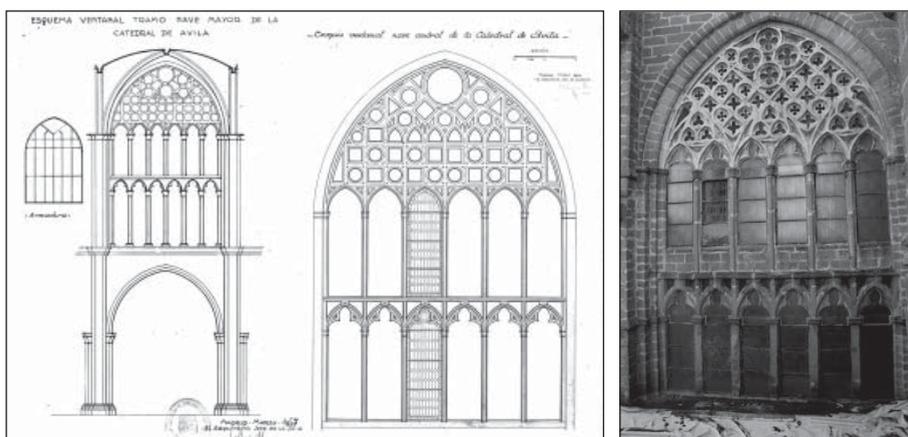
Plano de detalle del ventanal de un tramo de la nave mayor y detalle del despiece de la vidriera (Arenillas, 1957).
